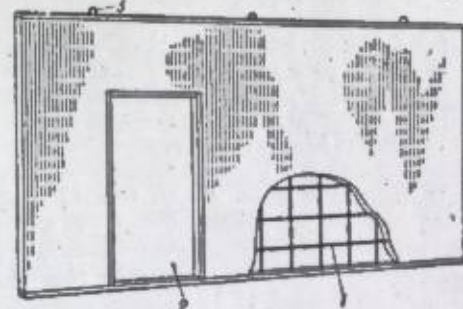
Перегородочная панель из гипсобетона: 1 — каркас; 2 — дверной проем; 3 — монтажная петля.
